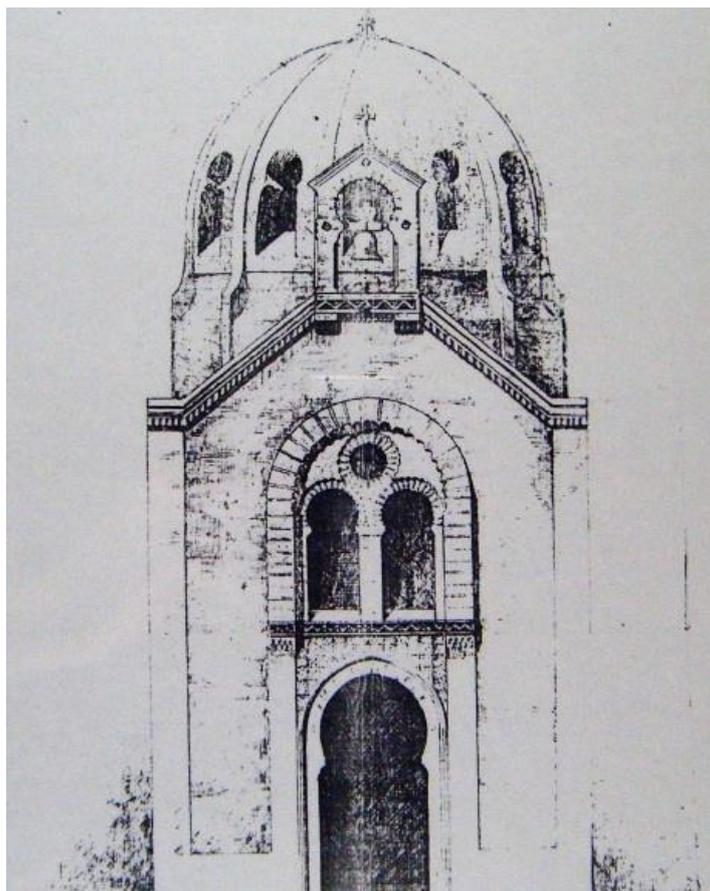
Fachada de la purísima Concepción proyectada por Aníbal Álvarez (ADT, Caja 538)
